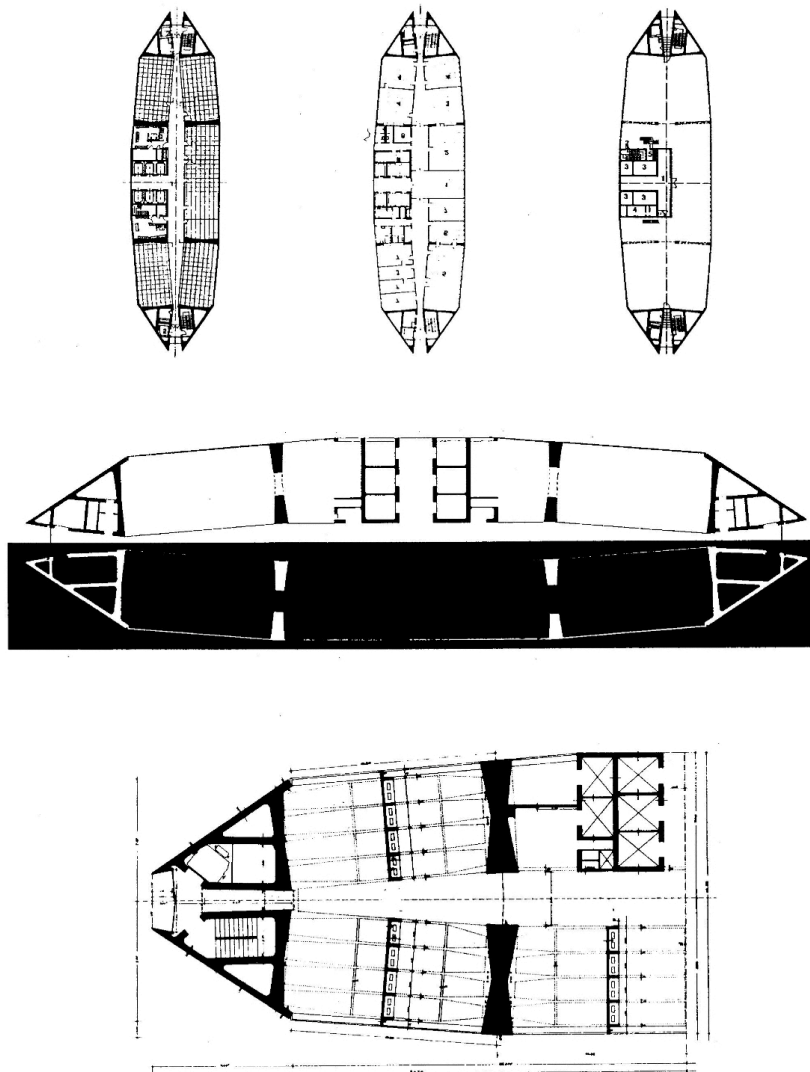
Gio Ponti, Immeuble Pirelli (d'après Irace, 1988) : (a) distribution des bureaux, (b) plan schématique comme slogan, (c) plan de structure d'un pignon.
